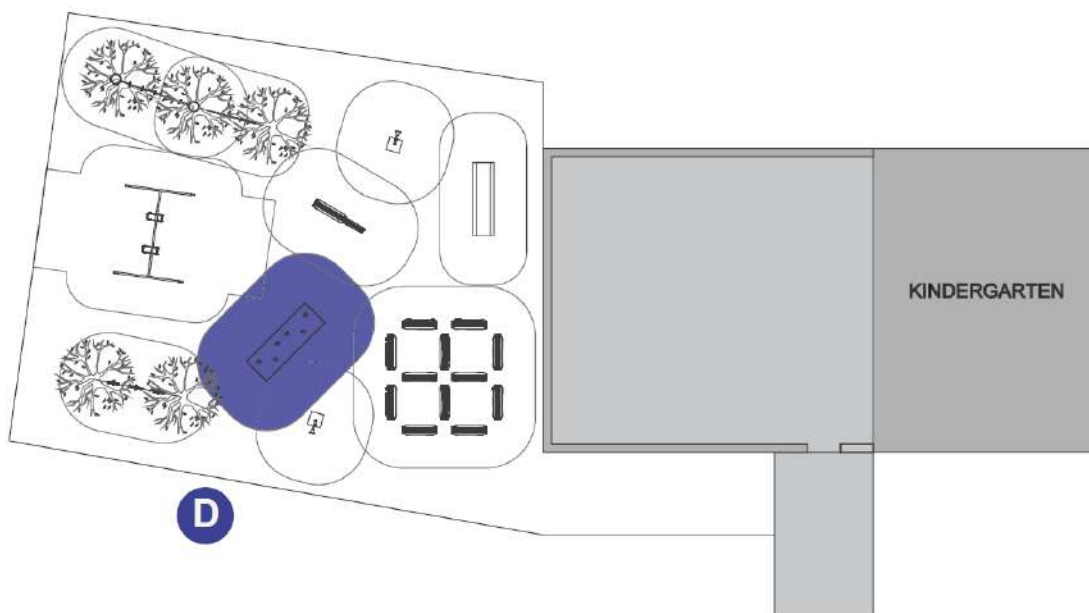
Elemento Tubo de hormigón finalizado. Fuente: propia
